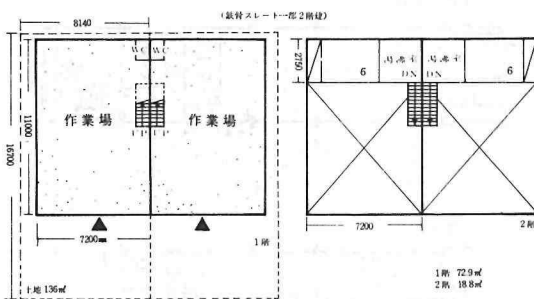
美原木工組合工場平面図(鉄骨スレート造一部2階建)
